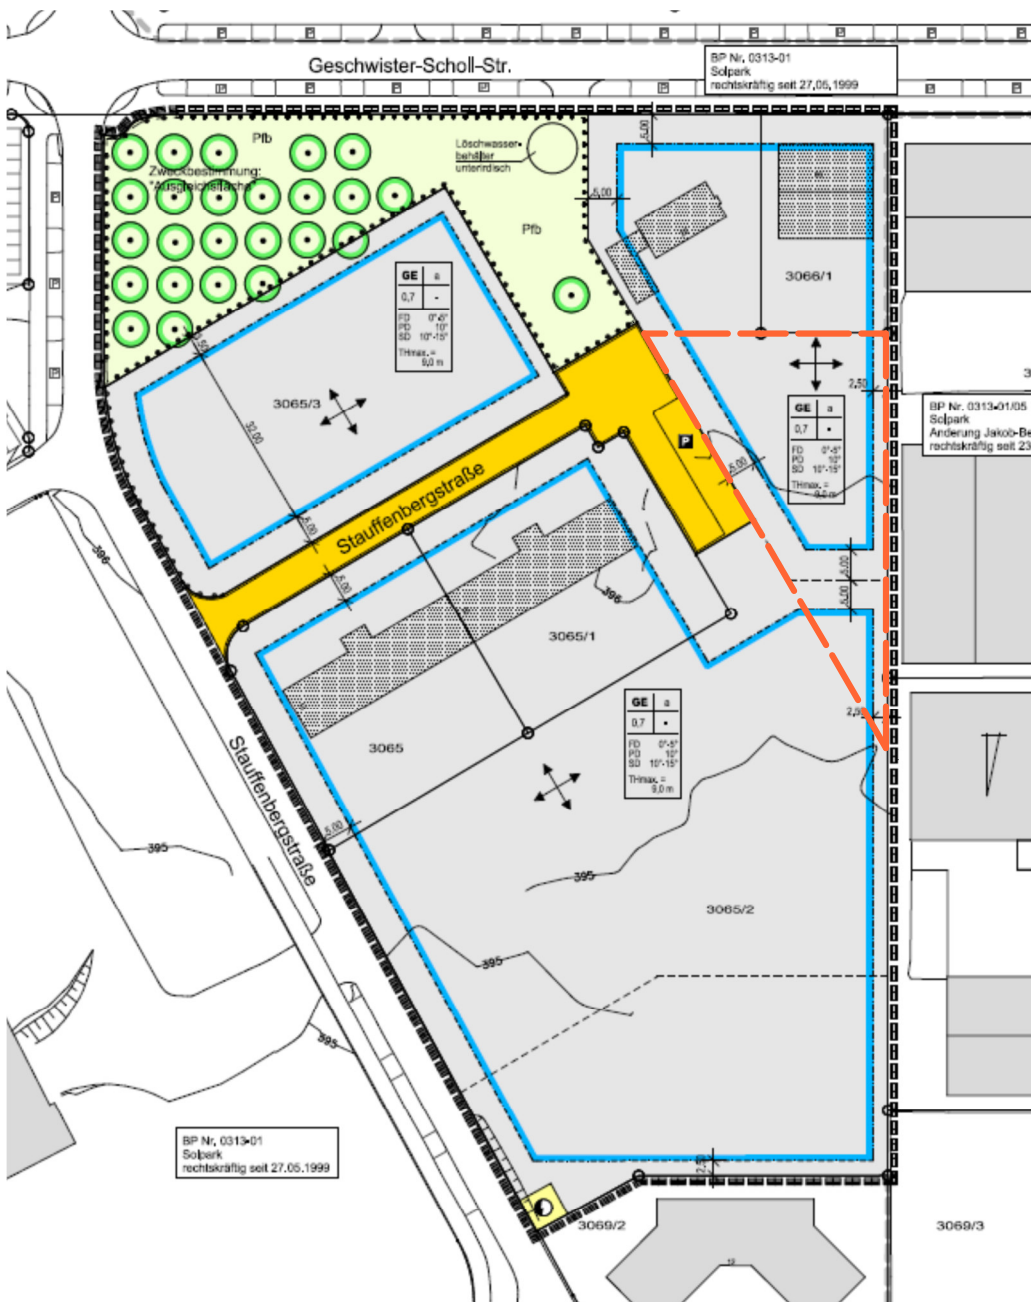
Bebauungsplan „Solpark Änderung Stauffenbergstraße“ (AGOS, 16.8.2019, Ausschnitt, ergänzt durch Bilanzierungsgebiet, orange gestrichelt)
